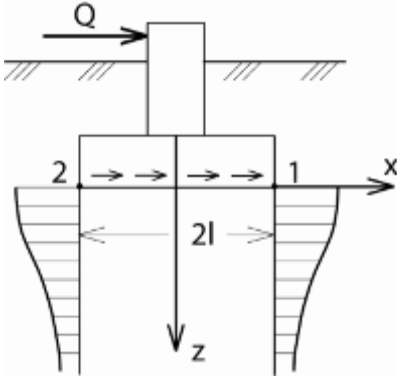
Схема распределения вертикальных напряжений в основании от горизонтальной нагрузки
